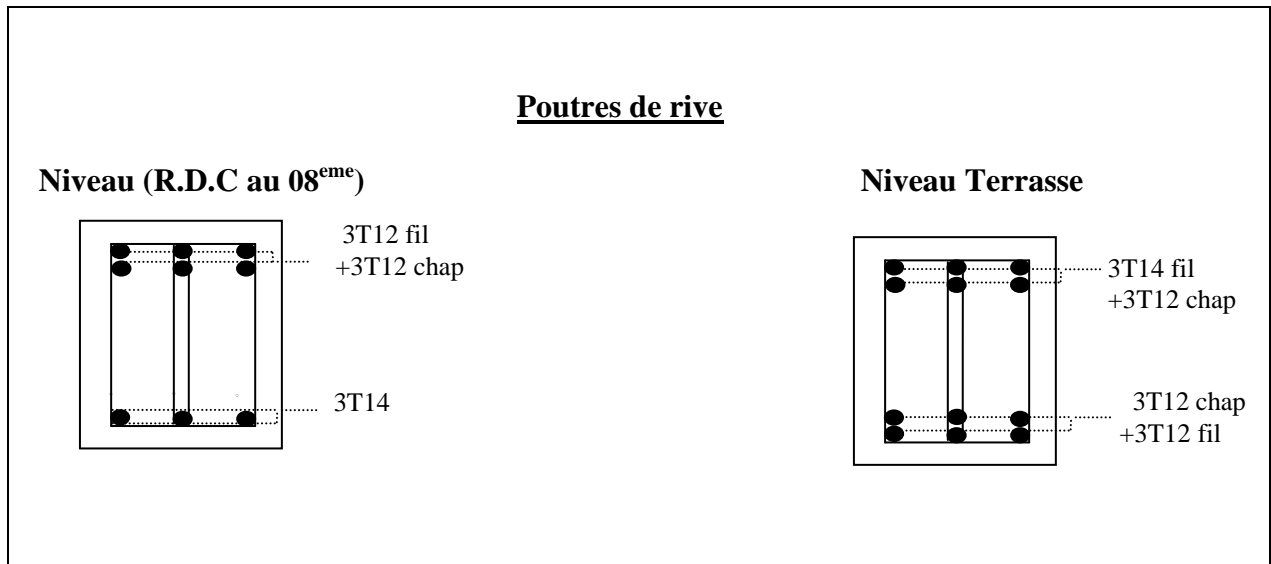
dessin de ferrailage des sections des poutres secondaire.
